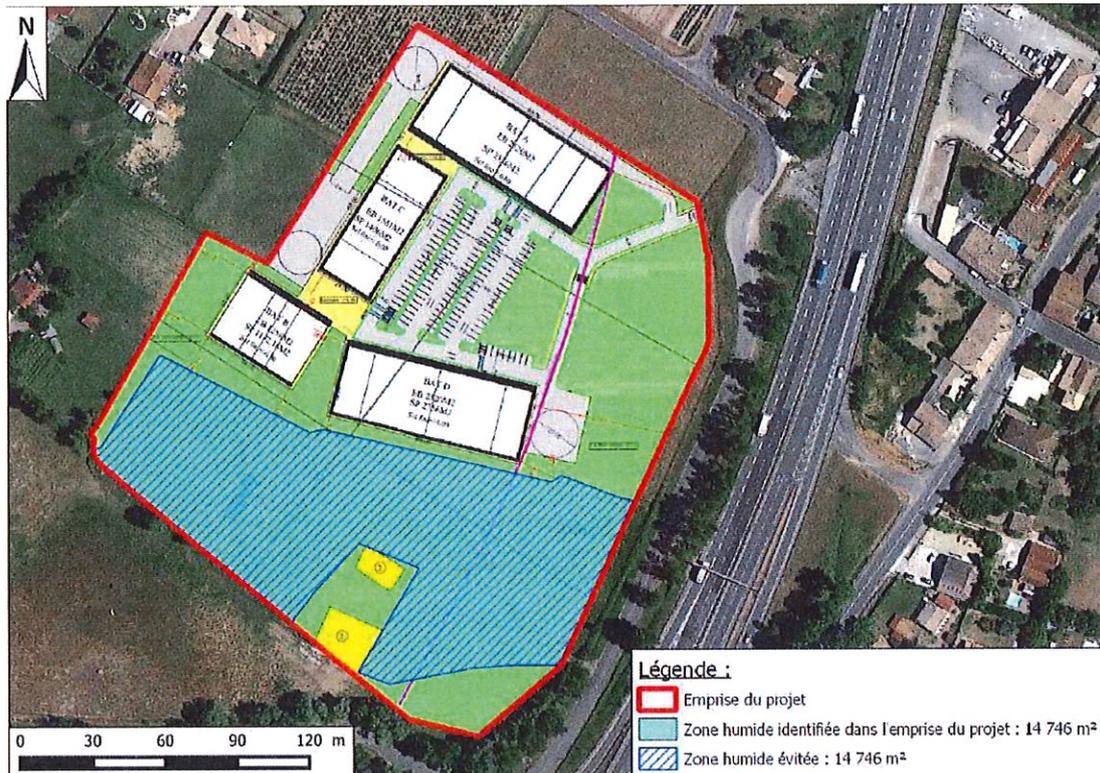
Plan masse du projet – septembre 2021 (Source : A URBANIS)
